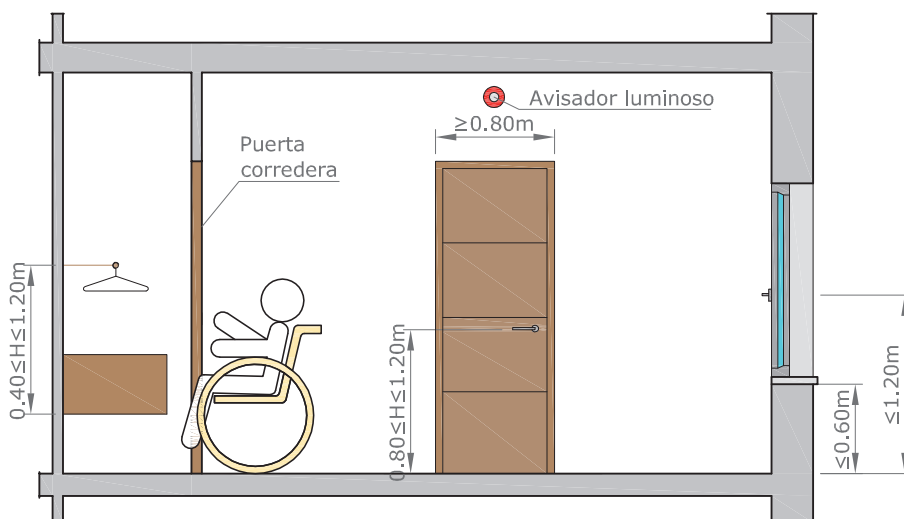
Sección de un dormitorio accesible con armario empotrado.
